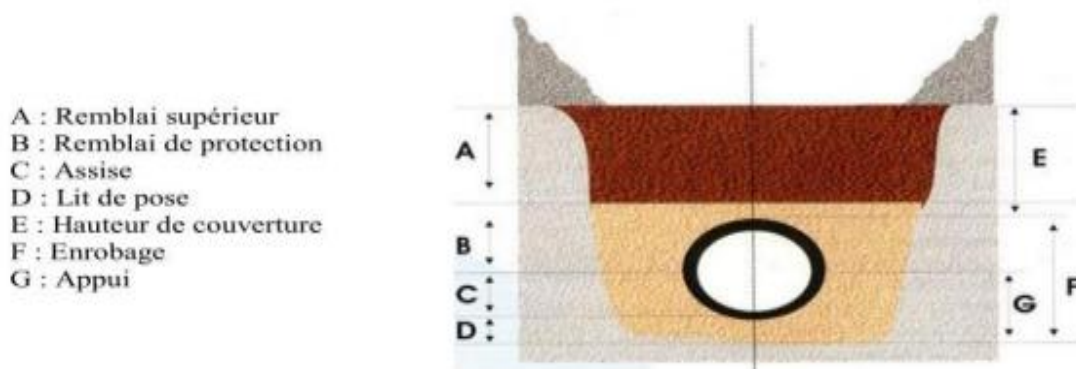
Pose et la protection de la conduite en tranchée. [10]
